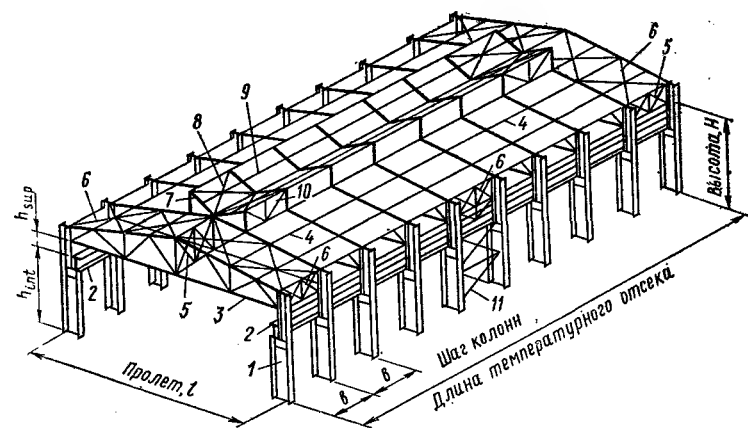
Конструктивная схема стального каркаса одноэтажного промышленного здания
